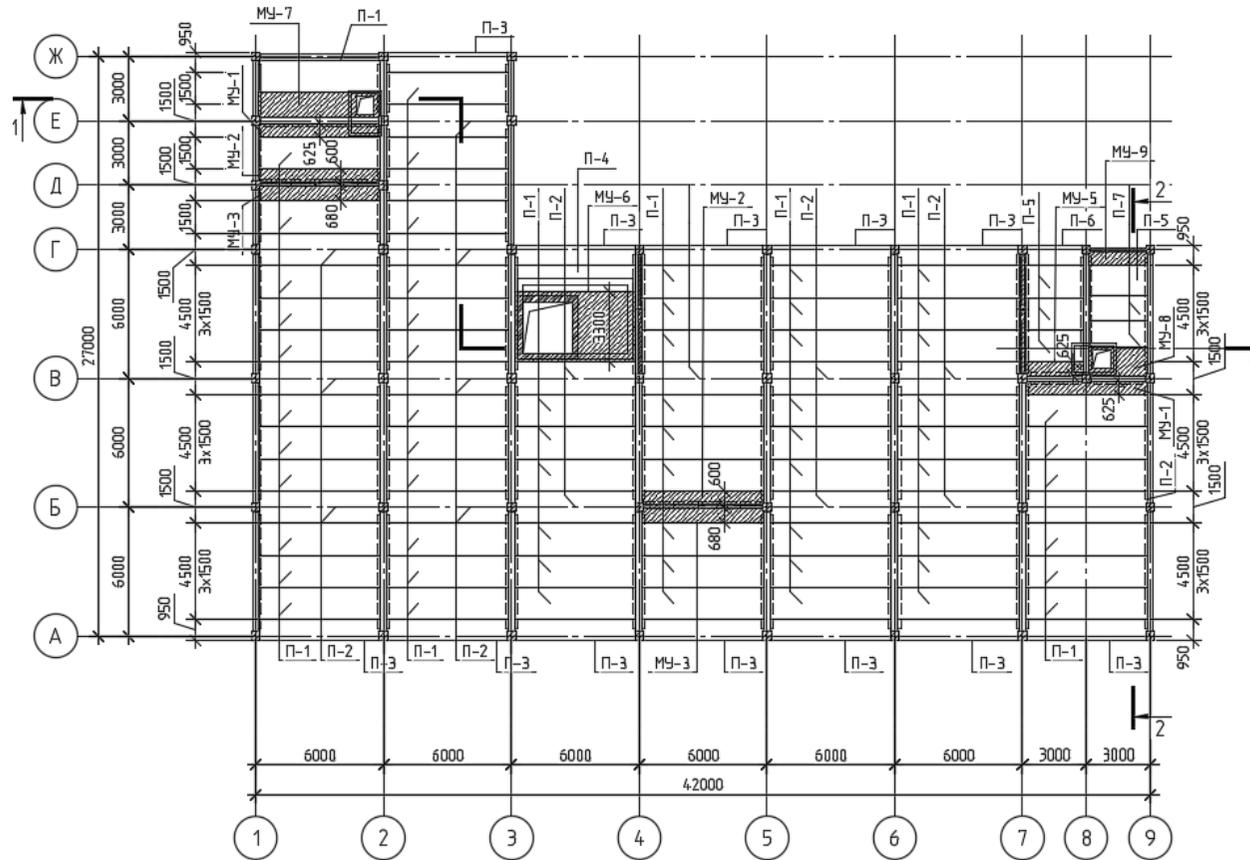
Схема расположения плит покрытия на отметке плюс 8,400
